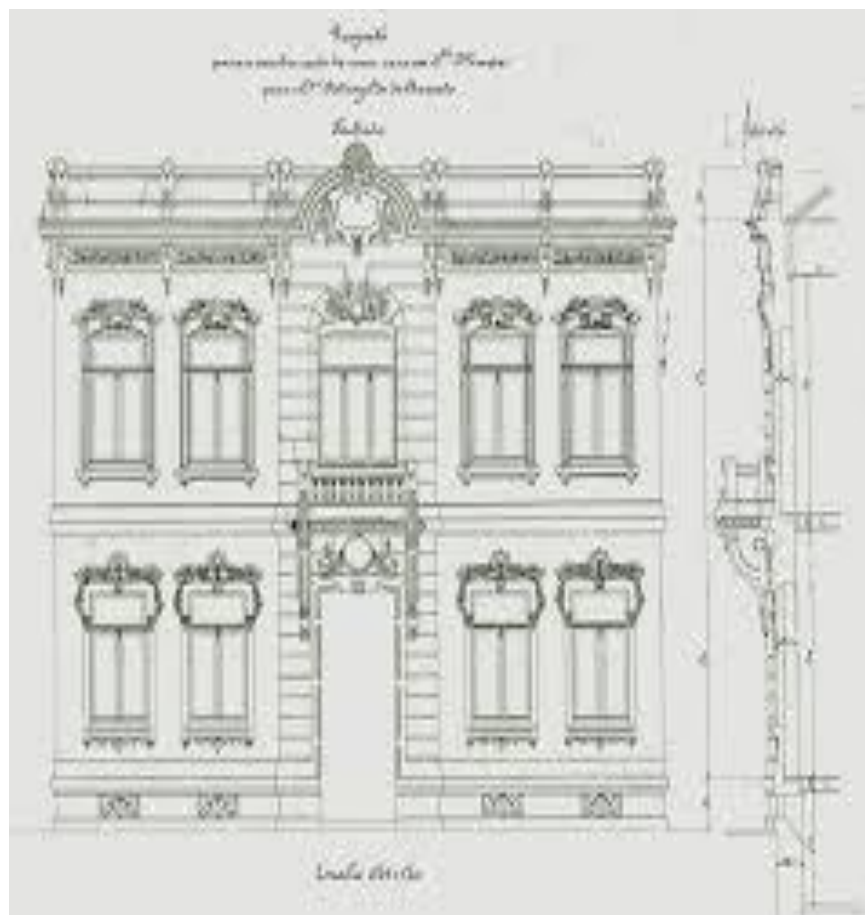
Planta do Palacete da Rua do Acampamento, nº8.
